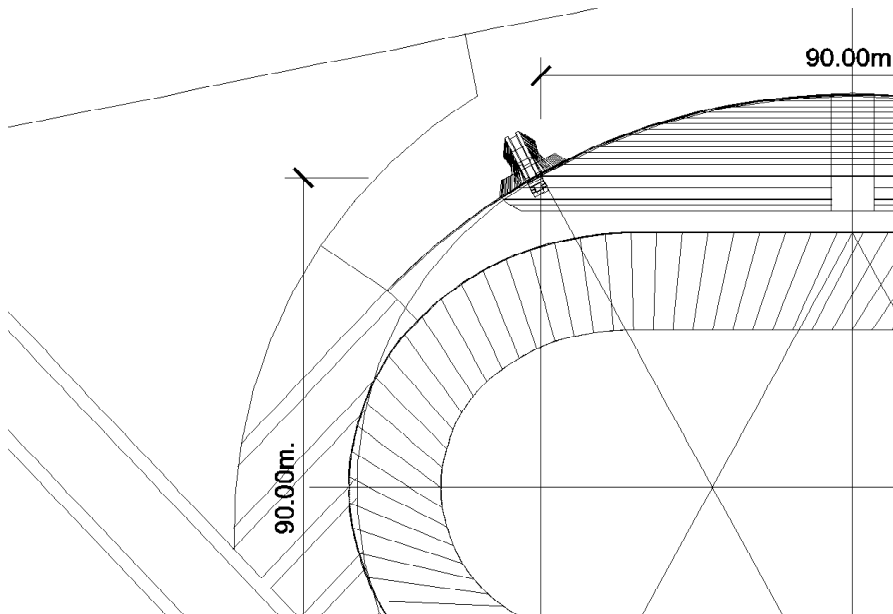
Vista de la planta en donde se han ubicado los soportes.
